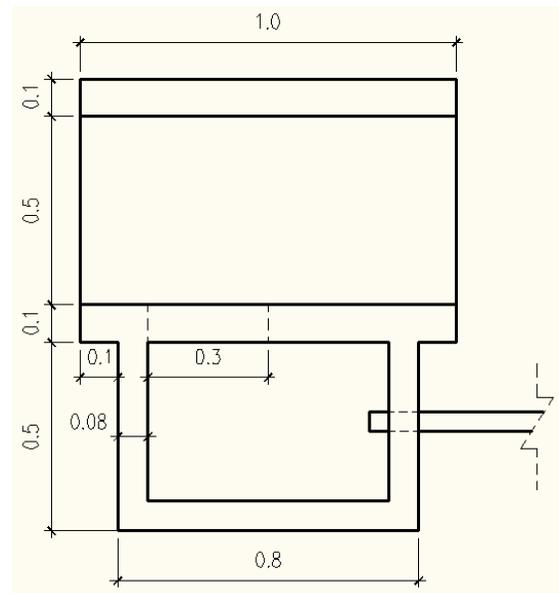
Vista de planta del vertedero y sedimentador (D. Salazar)
